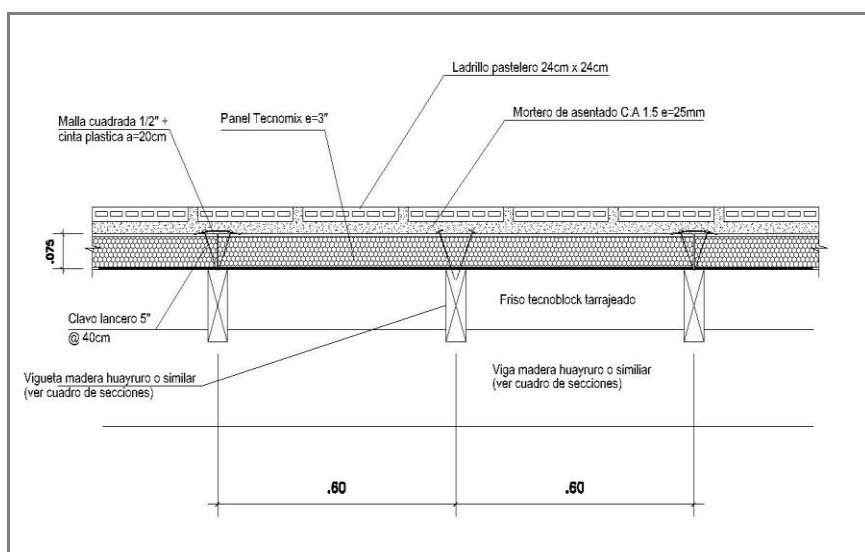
Detalle constructivo panel TECNOMIX e=3" con cubierta de ladrillo pastelero.
